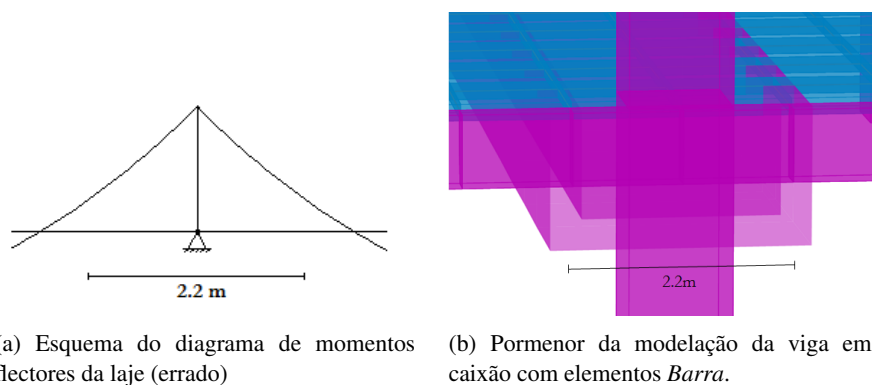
Pormenores da modelação da viga em caixão com elementos do tipo *Barra*.
